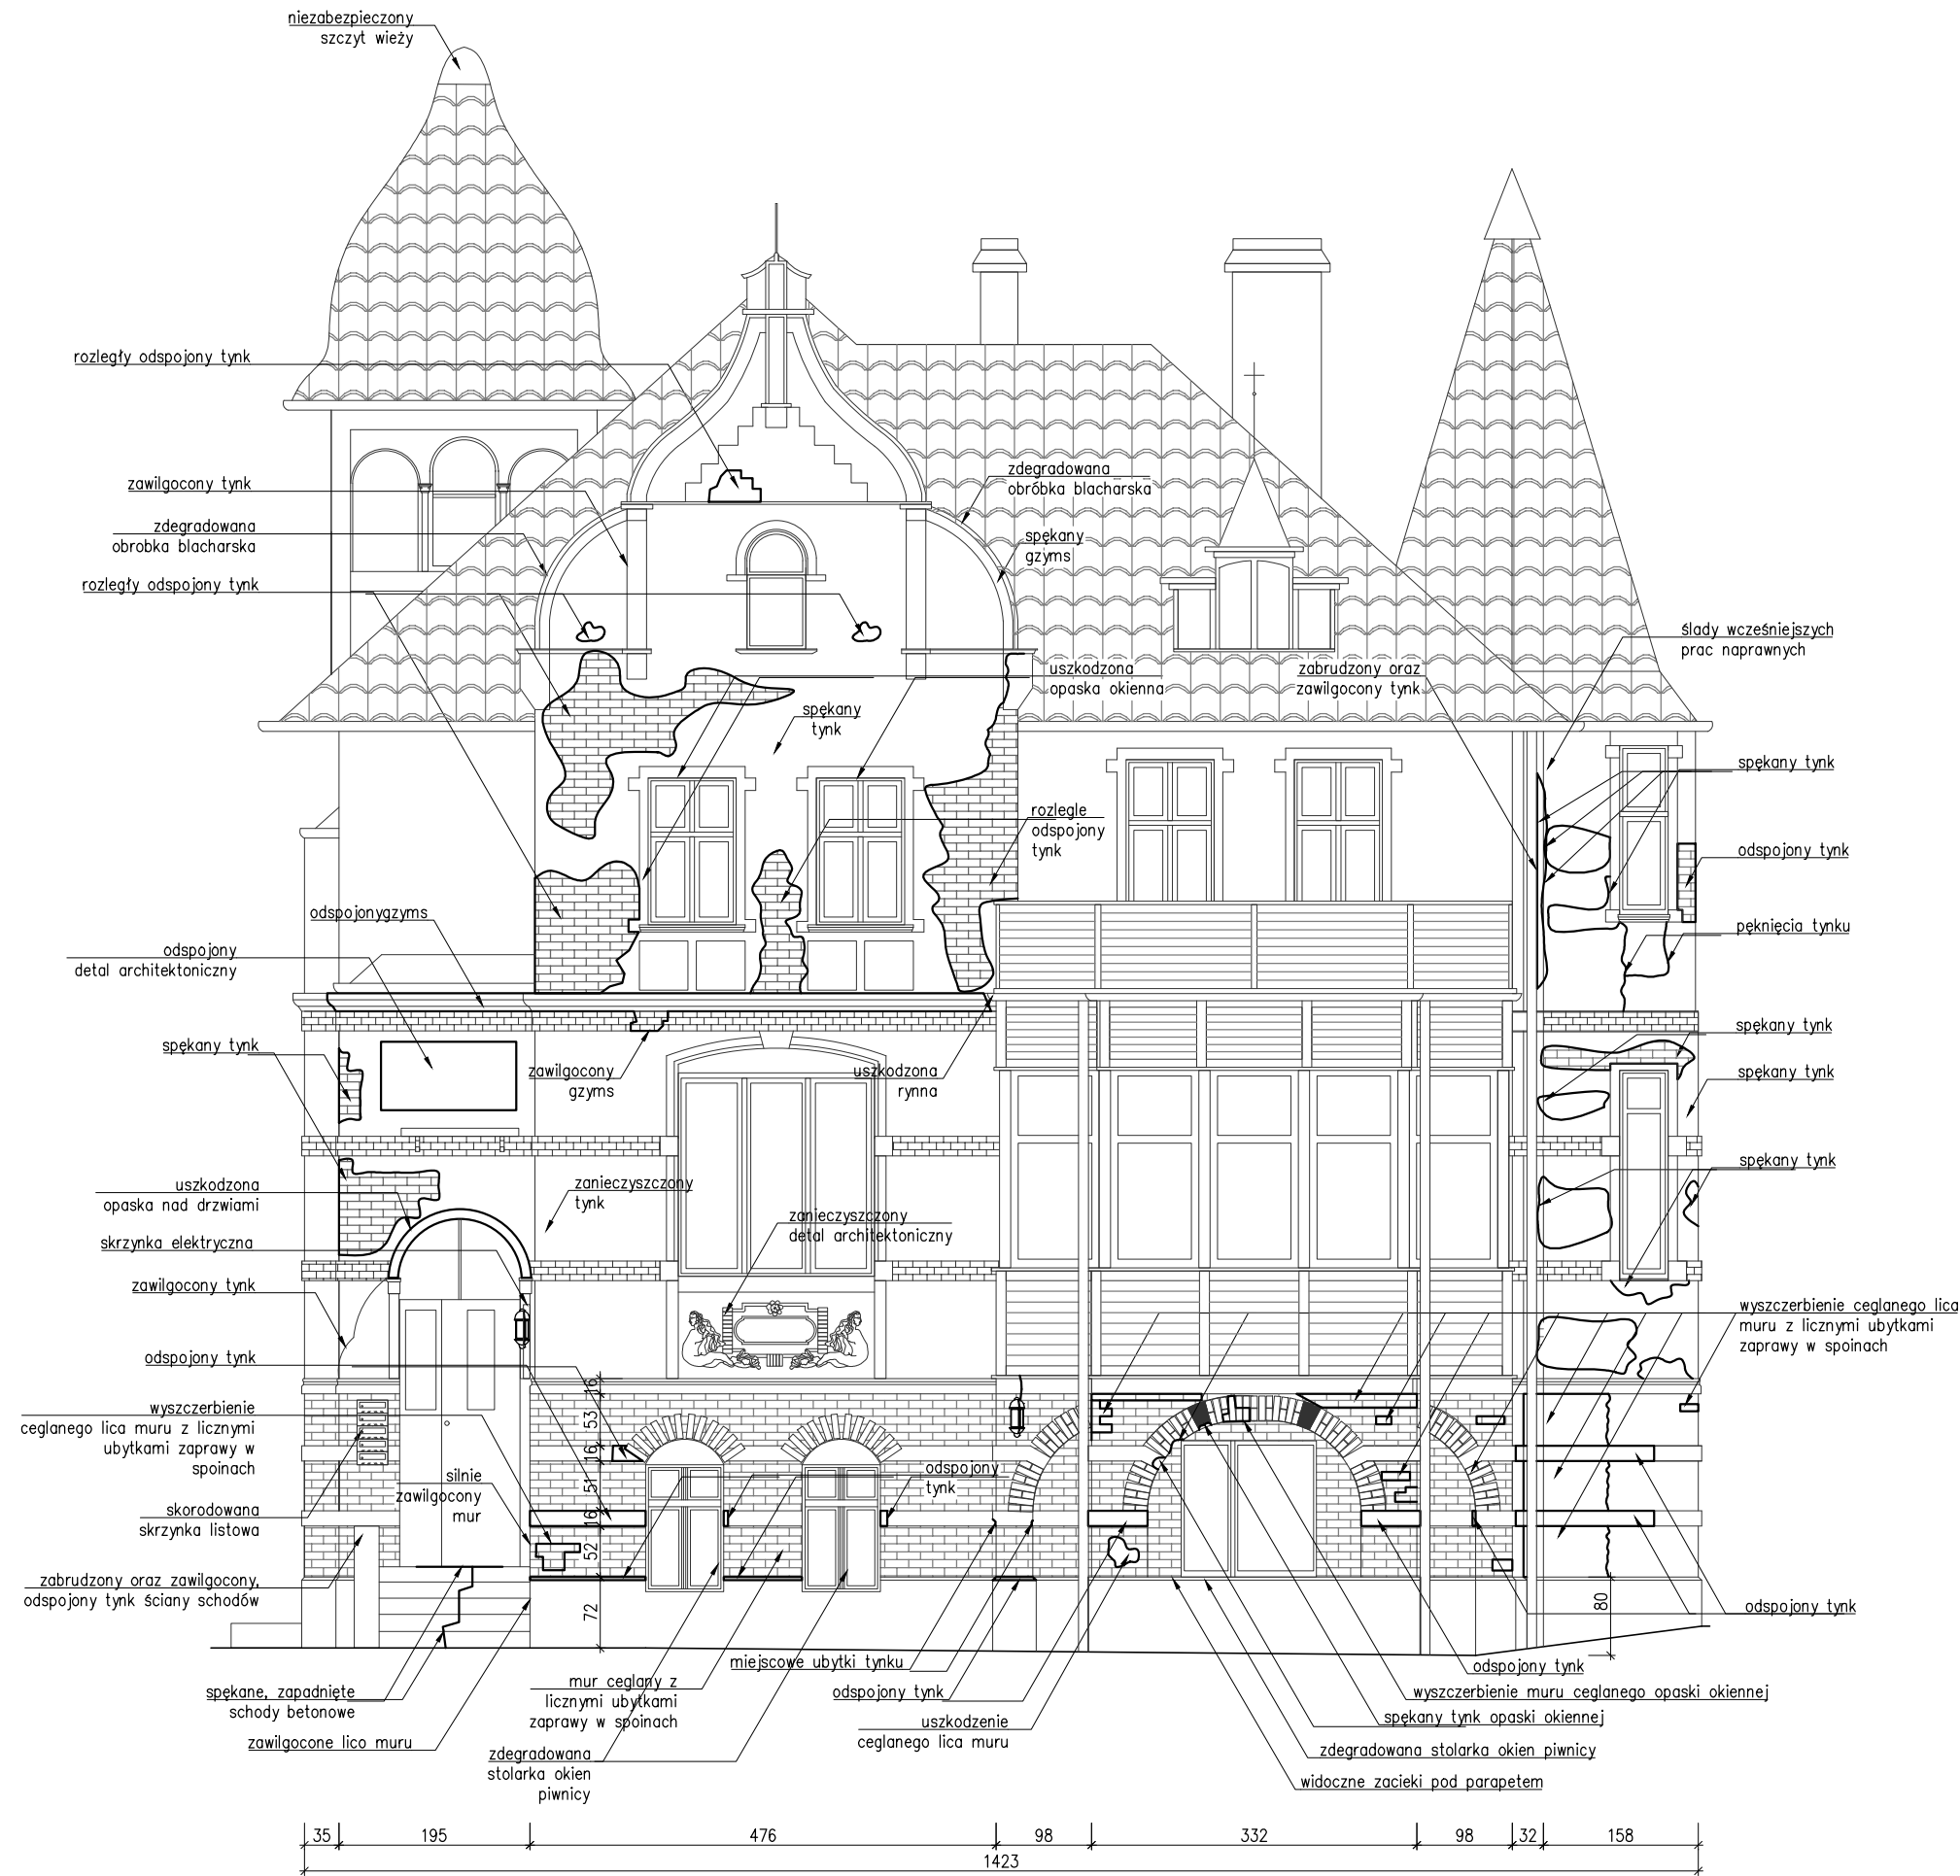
widok zawilgoconych i odspojonych tynków elewacji wschodniej
